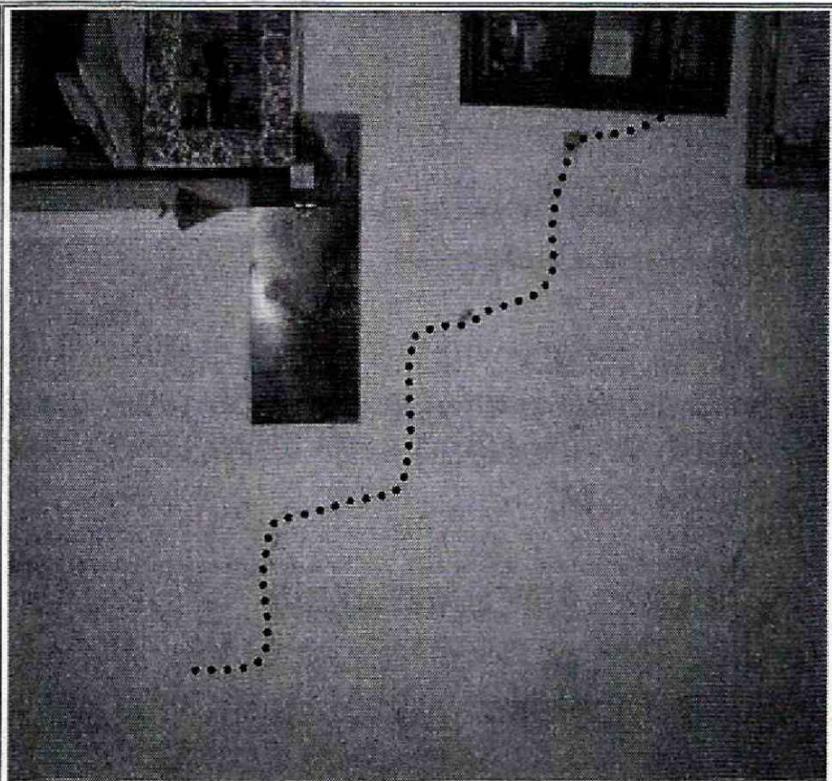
Fisura escalonada muro segundo nivel de la vivienda emplazada en el predio de la Calle 51 D Sur No. 4 – 01 Este
